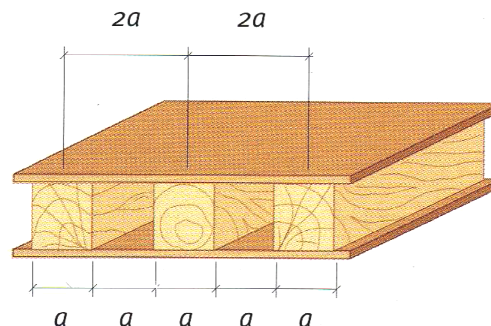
Esquema estrutural de um pavimento de madeira (Appleton, 2003).
